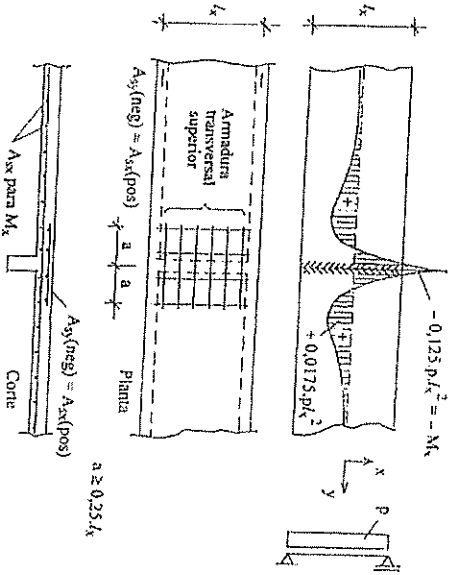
Momento transversal negativo em lajes armadas em uma direção
